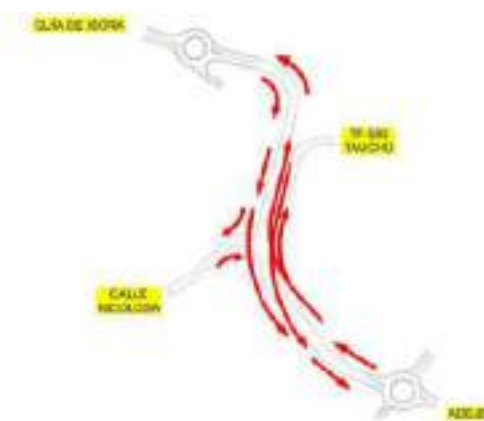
PLANTEAMIENTO VIARIO CON GLORIETAS EXTREMAS
